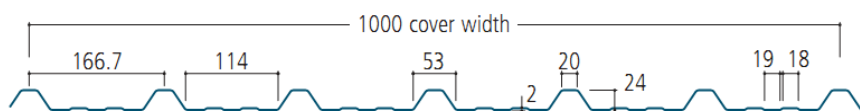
Chapa perfilada exterior AS24/1000 [89].
